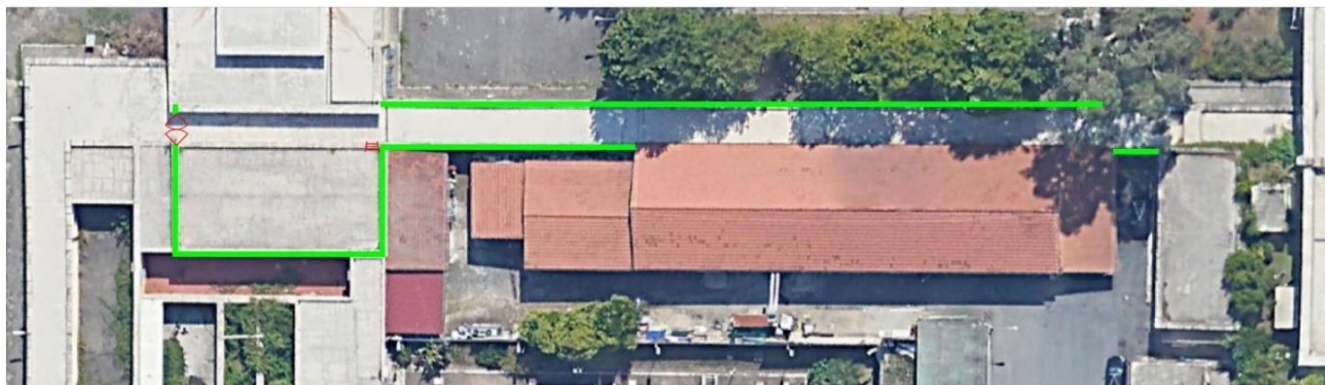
Schema della posa in opera dei parapetti
